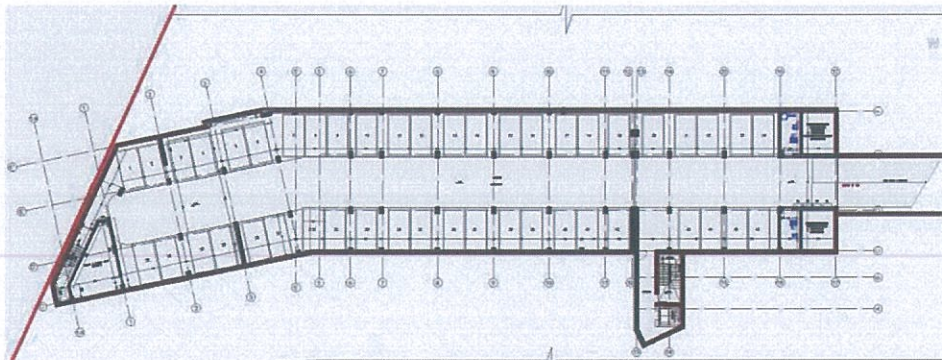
Planimetria kuote -3.00- Parkim- Sip. 1744.88 m<sup>2</sup>
